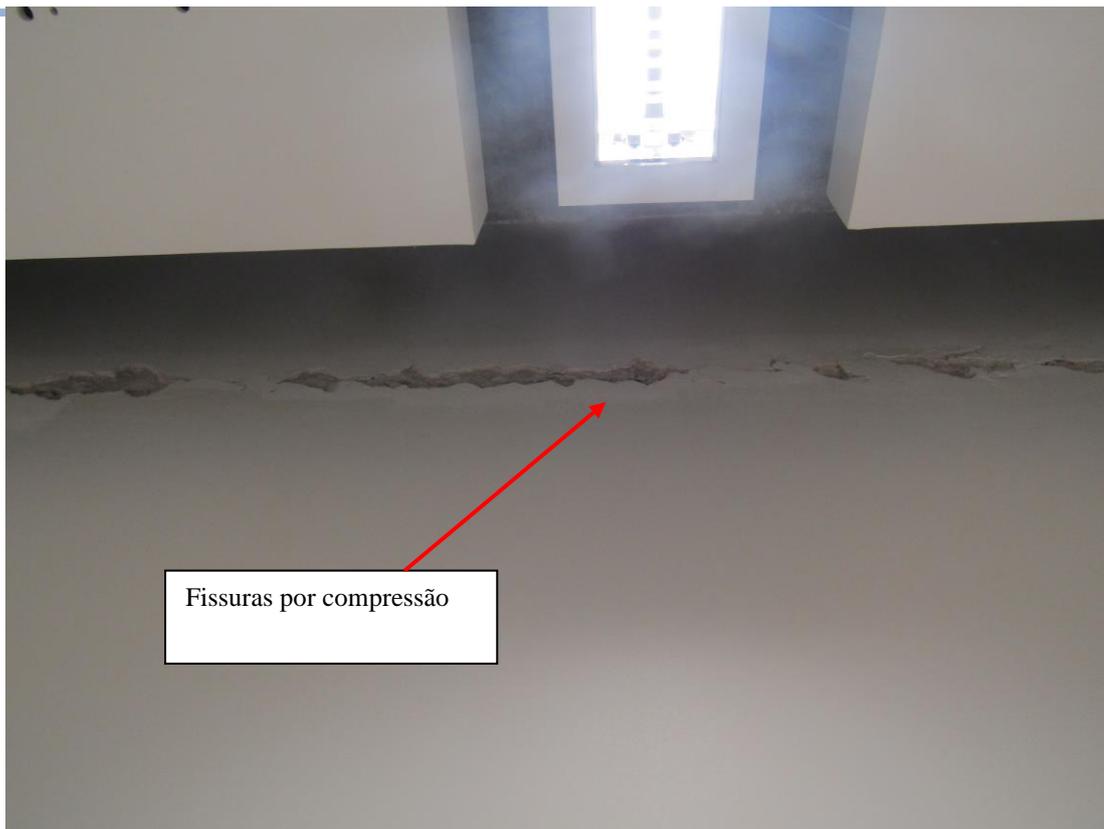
FISSURAÇÃO NA LIGAÇÃO ALVENARIA/PORTICO BETÃO
